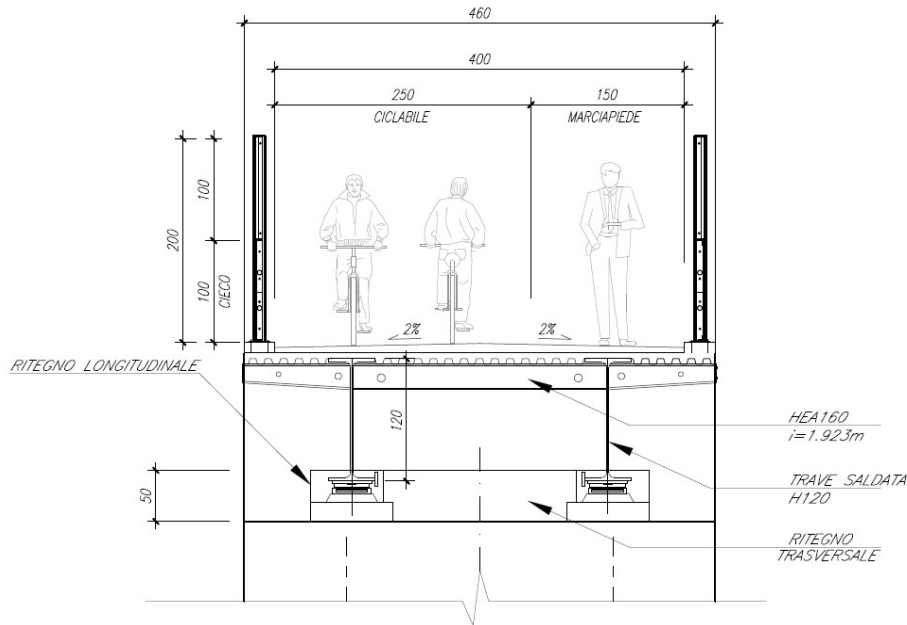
Sezione trasversale tipo dell'impalcato: sezione corrente
